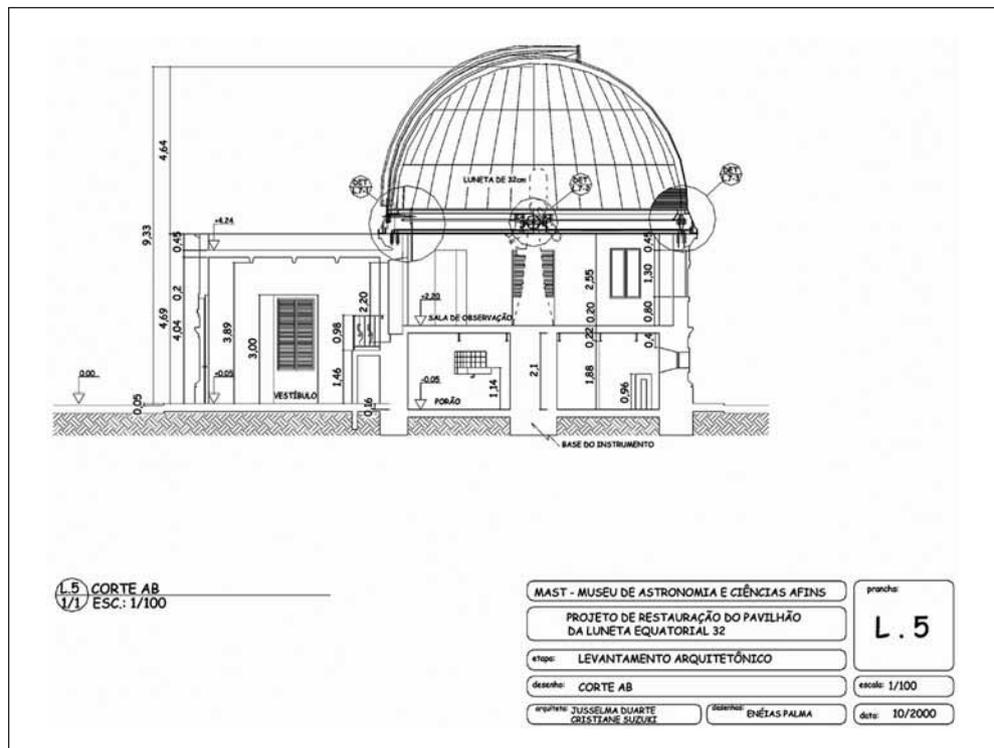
Planta de corte do pavilhão de estudo (AB).
